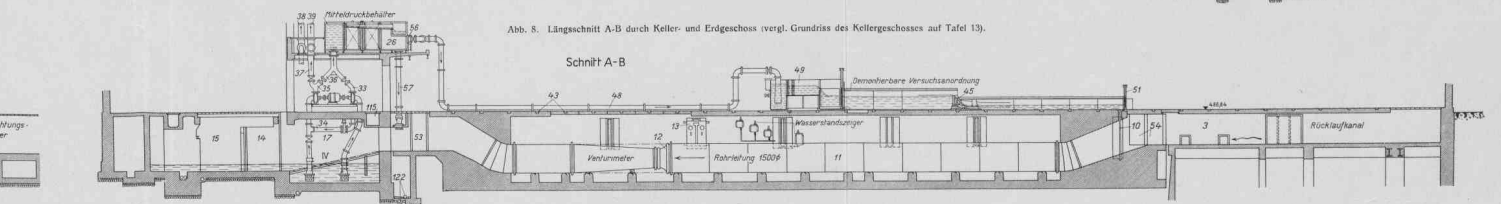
Längsschnitt A-B durch Keller- und Erdgeschoss (vergl. Grundriss des Kellergeschosses auf Tafel 13).
